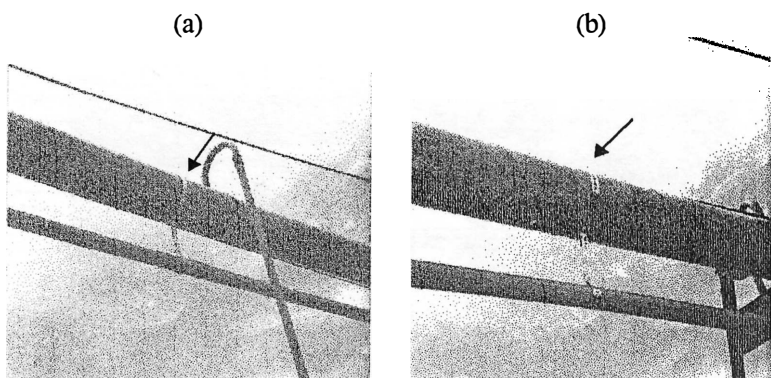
Braçadeiras do sistema de adução de calda: (a) braçadeira de aço chato galvanizado, (b) braçadeira de aço flexível galvanizado
